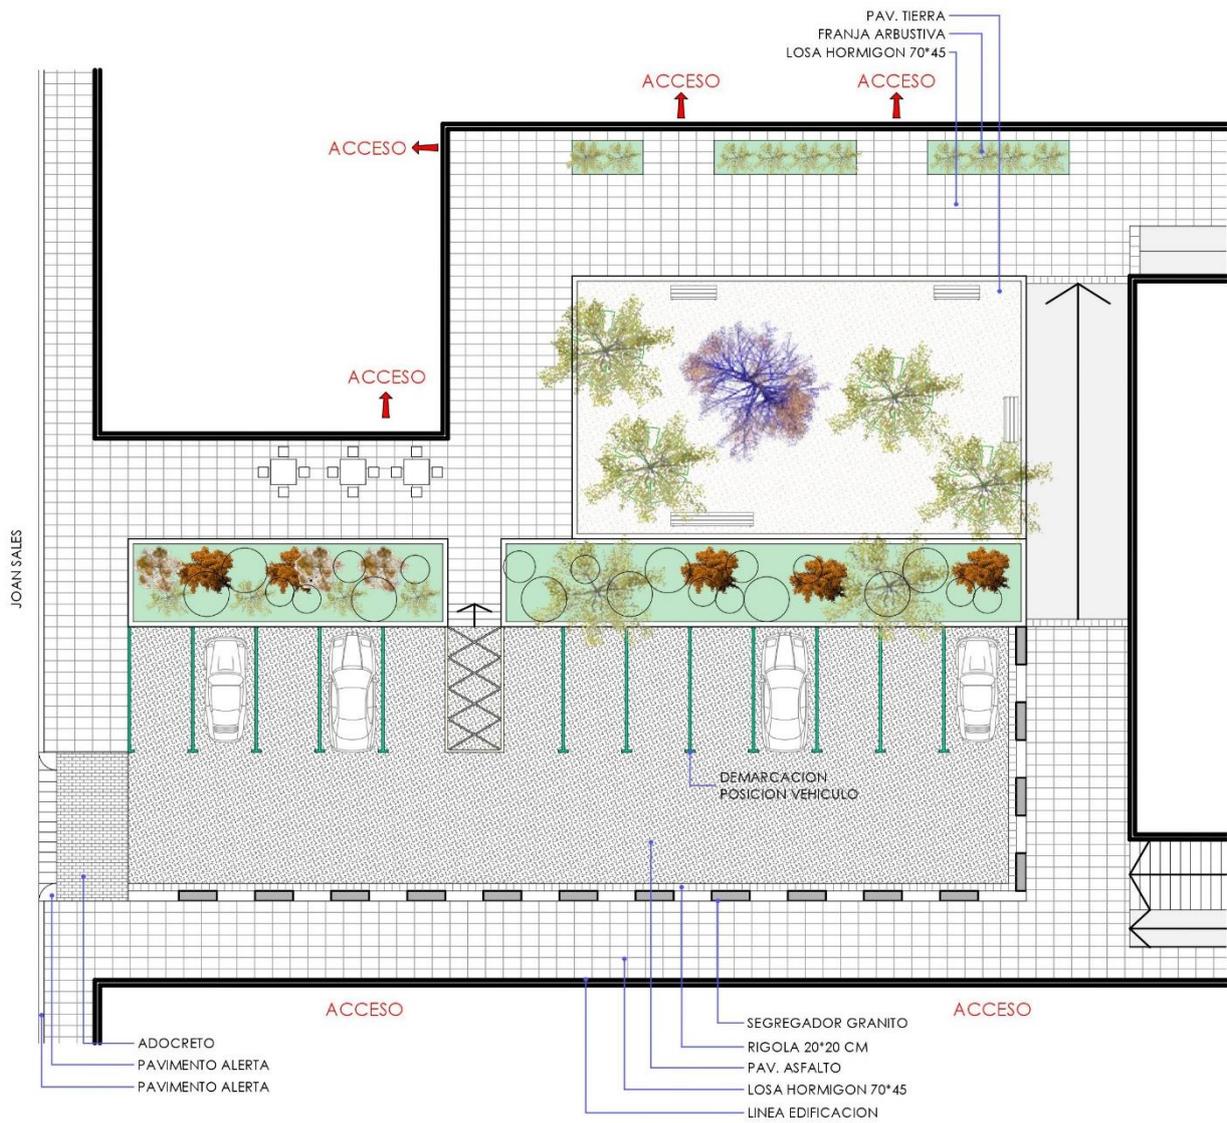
Planta de solución tipo en la intervención de las placetas con aparcamiento que conforman los bloques L.
